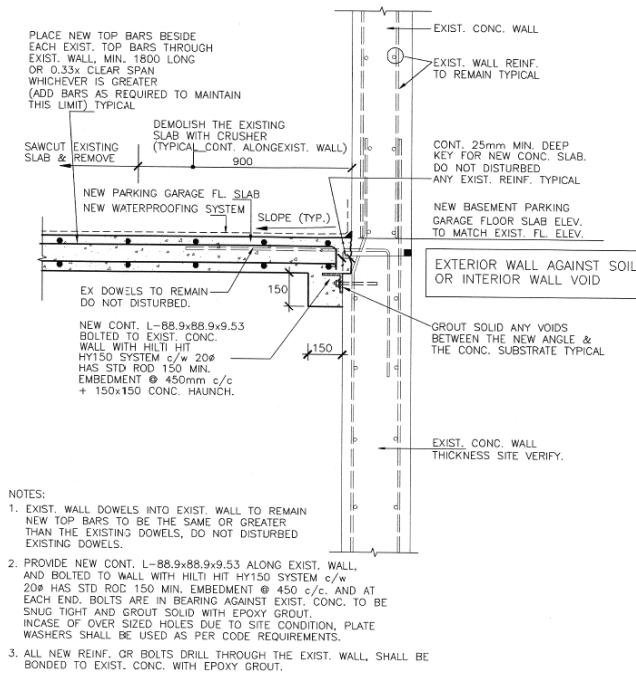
Imbinarea noul planșeu din beton armat cu peretele exterior existent - secțiune tipică.
